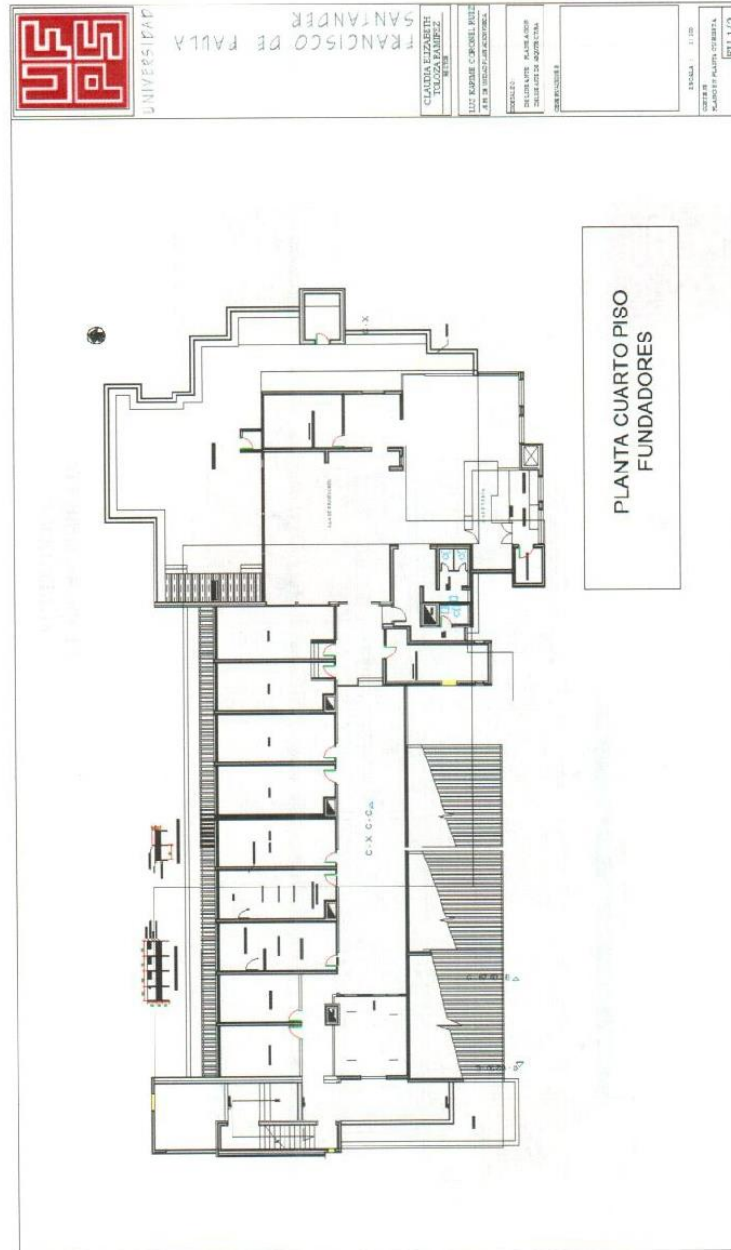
VISTA EN PLANTA. CUARTO PISO EDIFICIO DE FUNDADORES.
